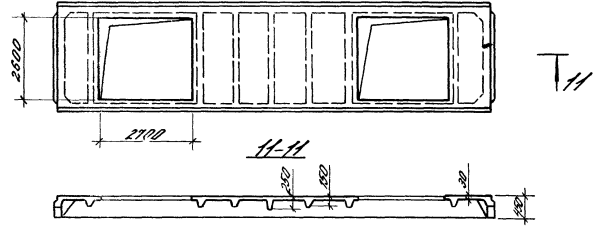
Плита типоразмера 211012 с двумя проемами для зенитных фонарей
